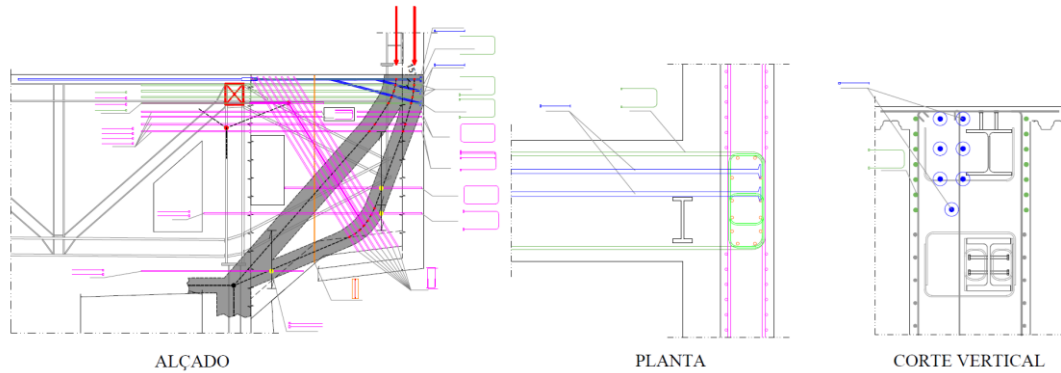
Modelo de escoras e tirantes com pormenorização das vigas-parede.
